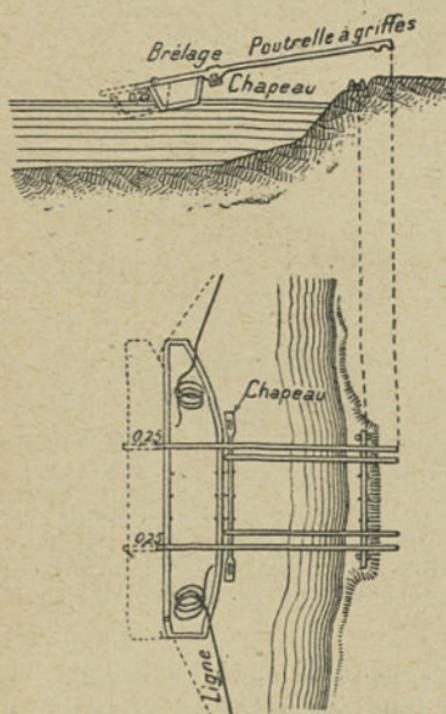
Mise en place d'un chevalet à l'aide d'un bateau.
